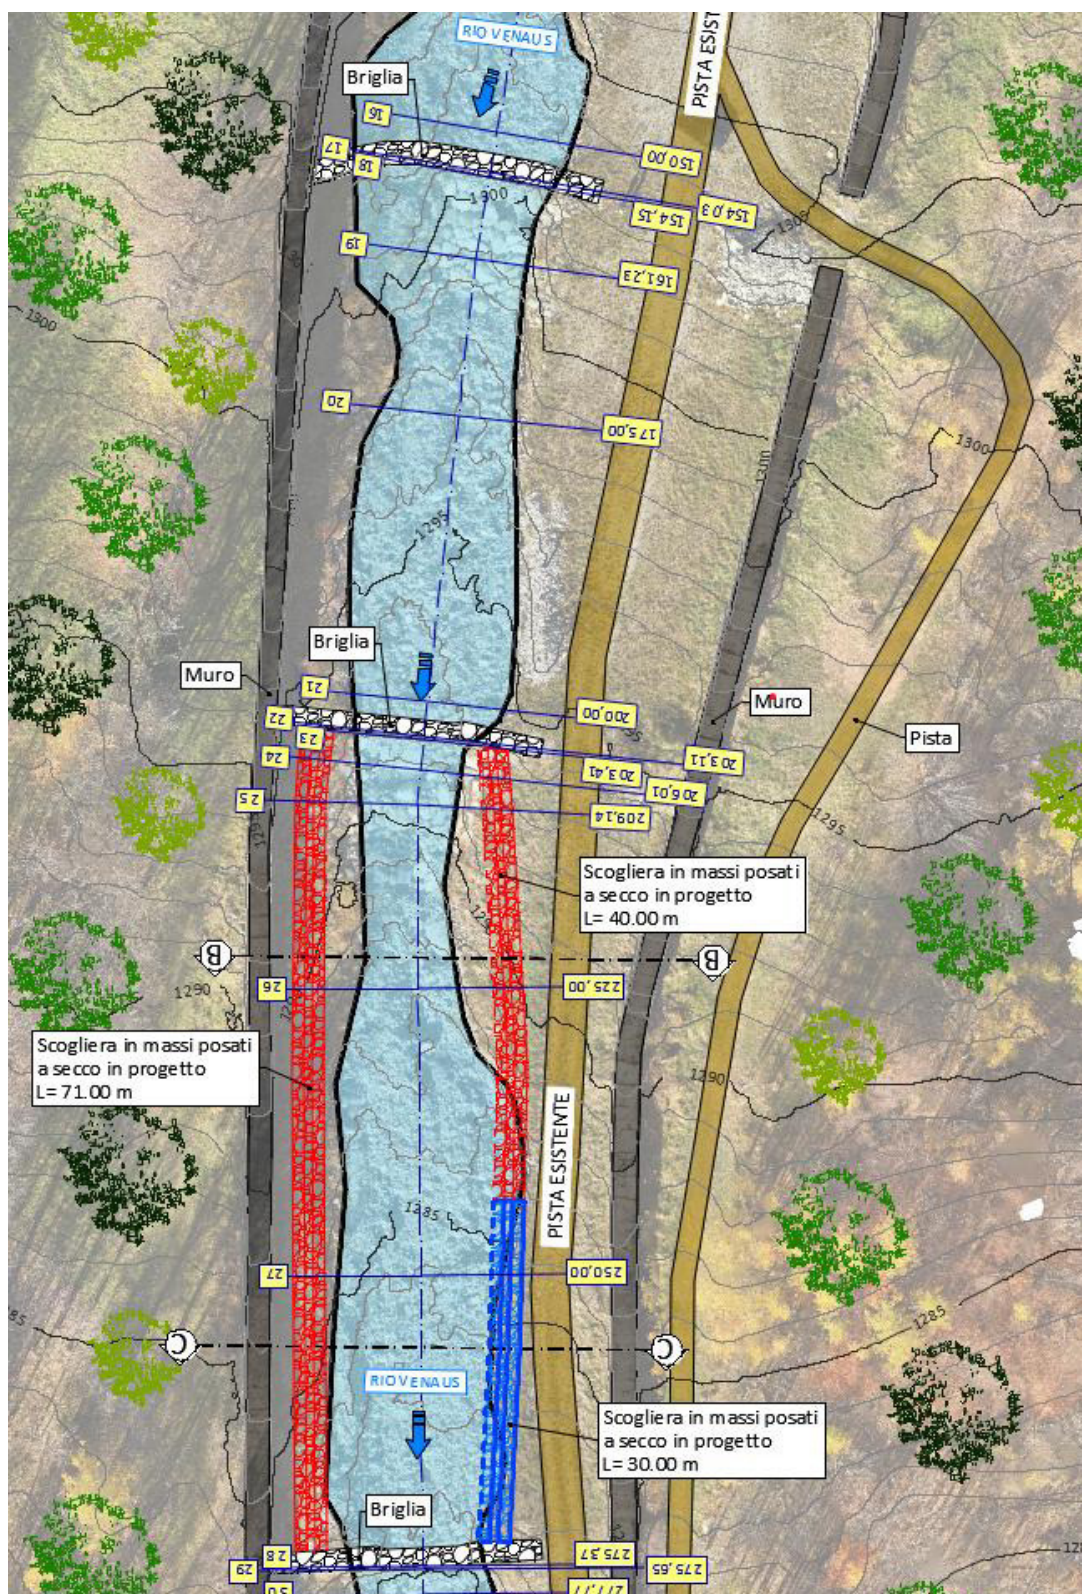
Estratto della planimetria Tav.05 Planimetria di progetto.
